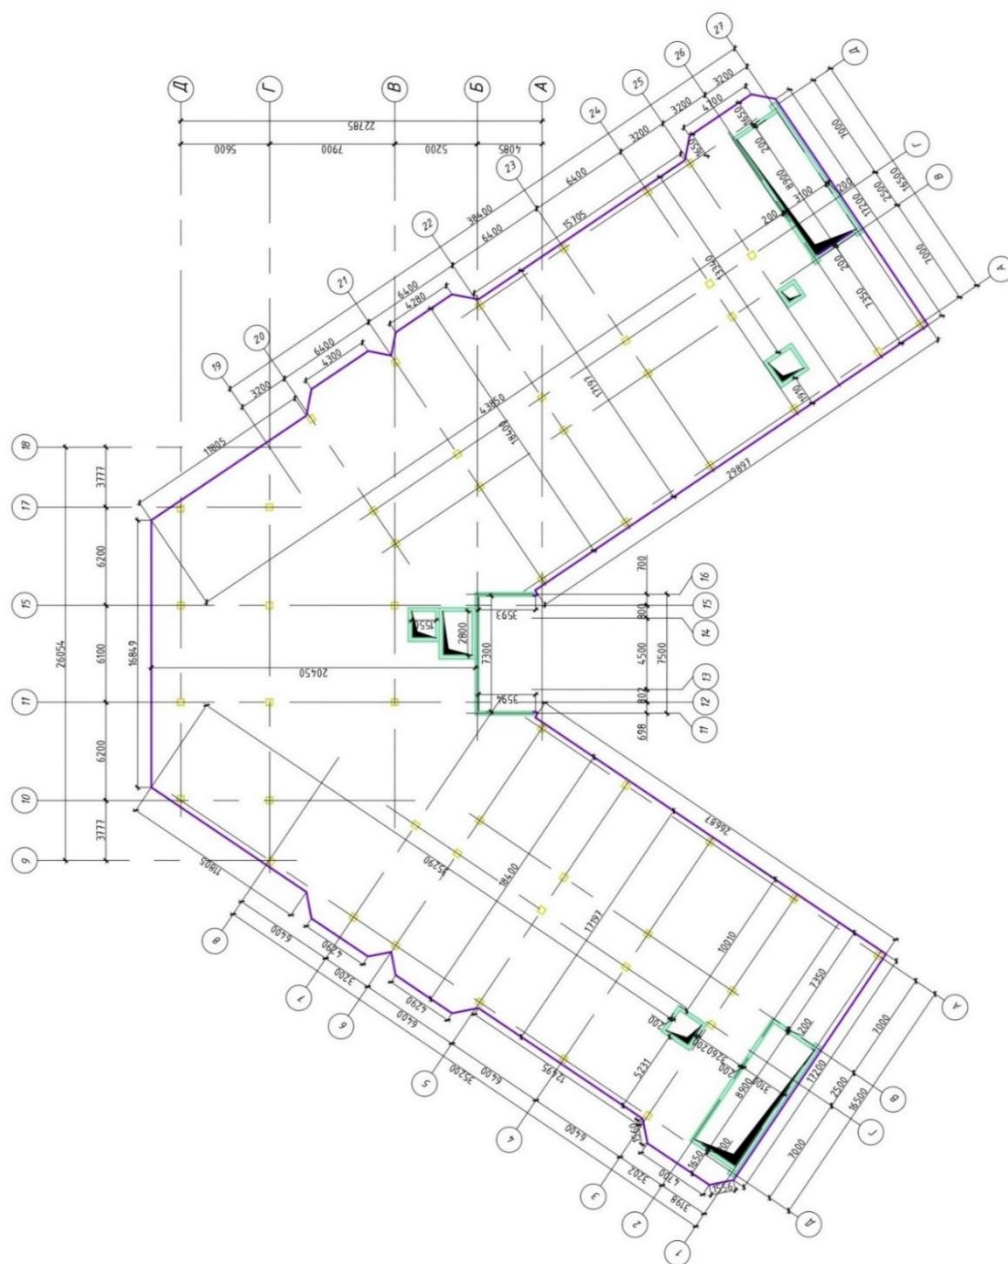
Опалубочный план плиты перекрытия ПМ-1 на отметке +9,000
